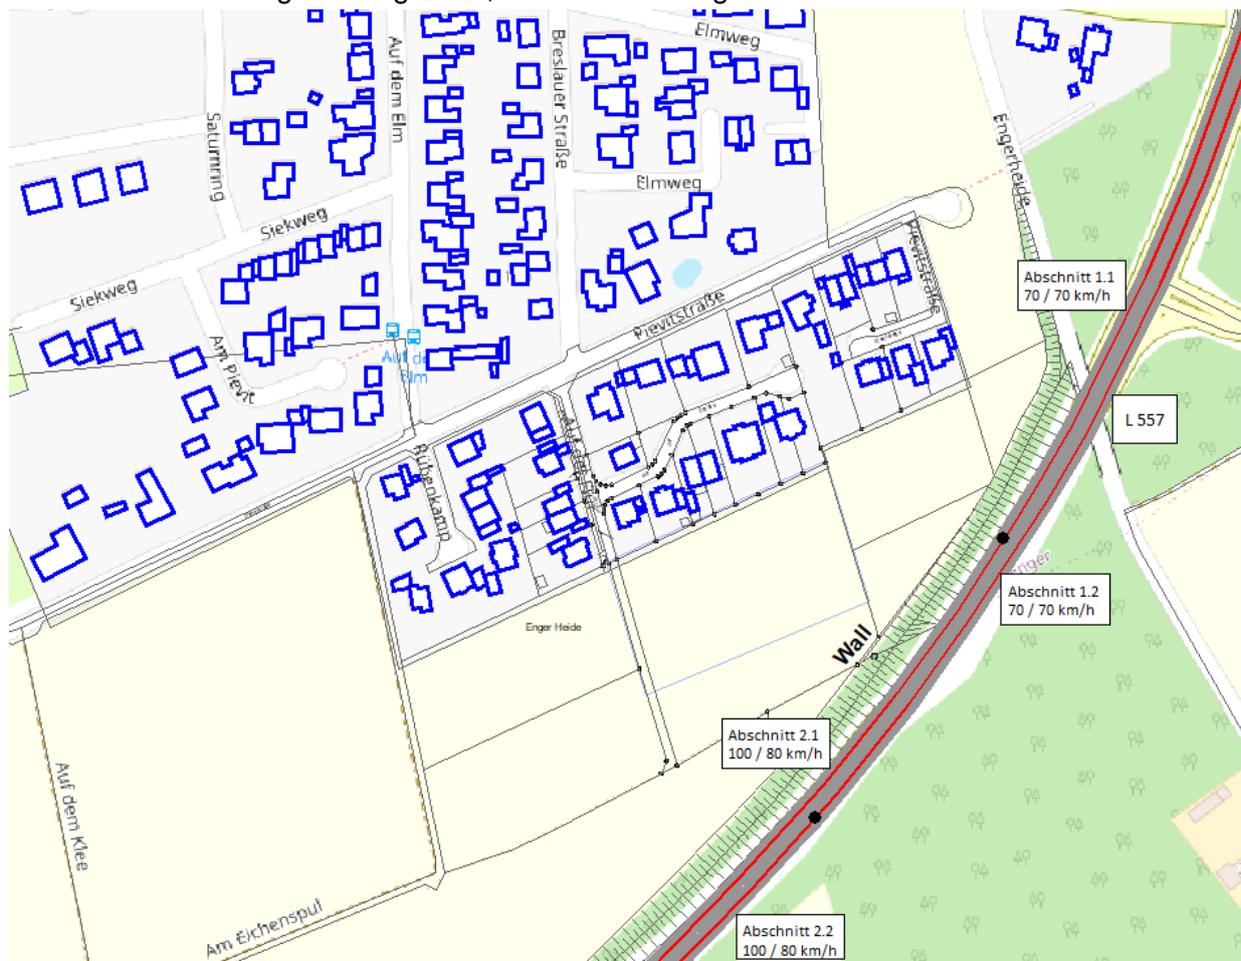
Übersichtslageplan - Straßenabschnitte
